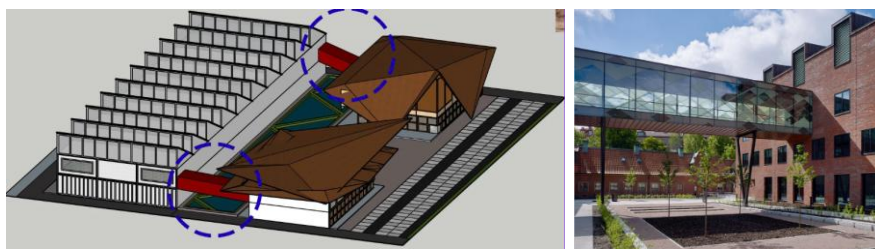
Konsep Tampilan Massa Retail dan Café.
